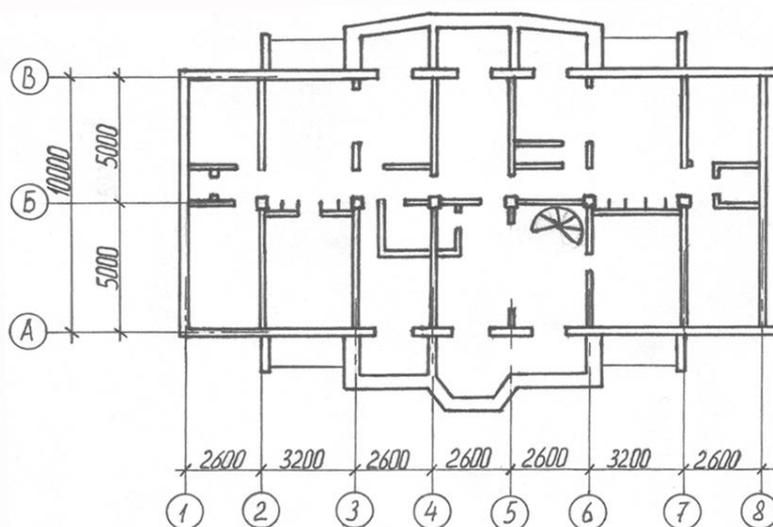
План пятого этажа (1-й вариант проектной разработки)
